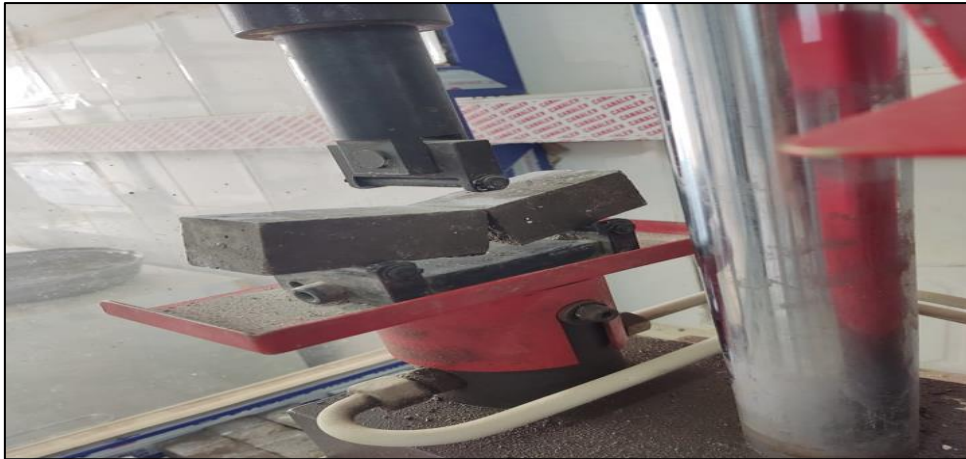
Dispositif de l'essai mécanique de rupture par flexion.
